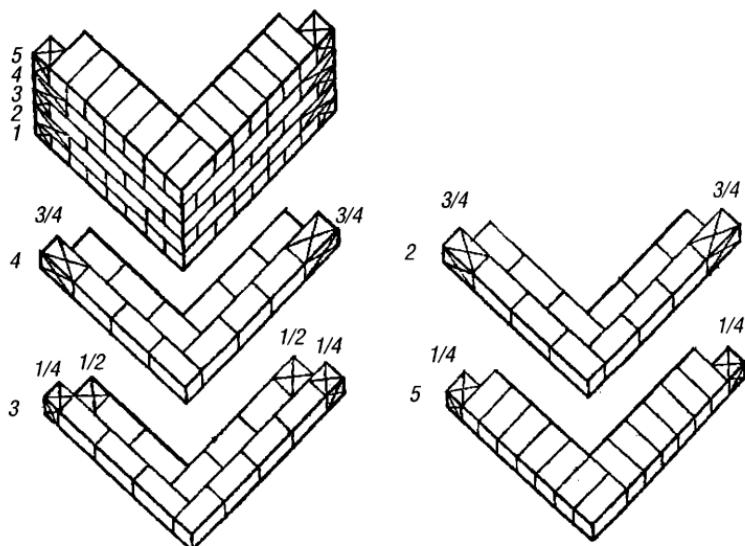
Сплошная кирпичная кладка наружных стен с образованием прямого угла и четвертей оконных и дверных проемов
